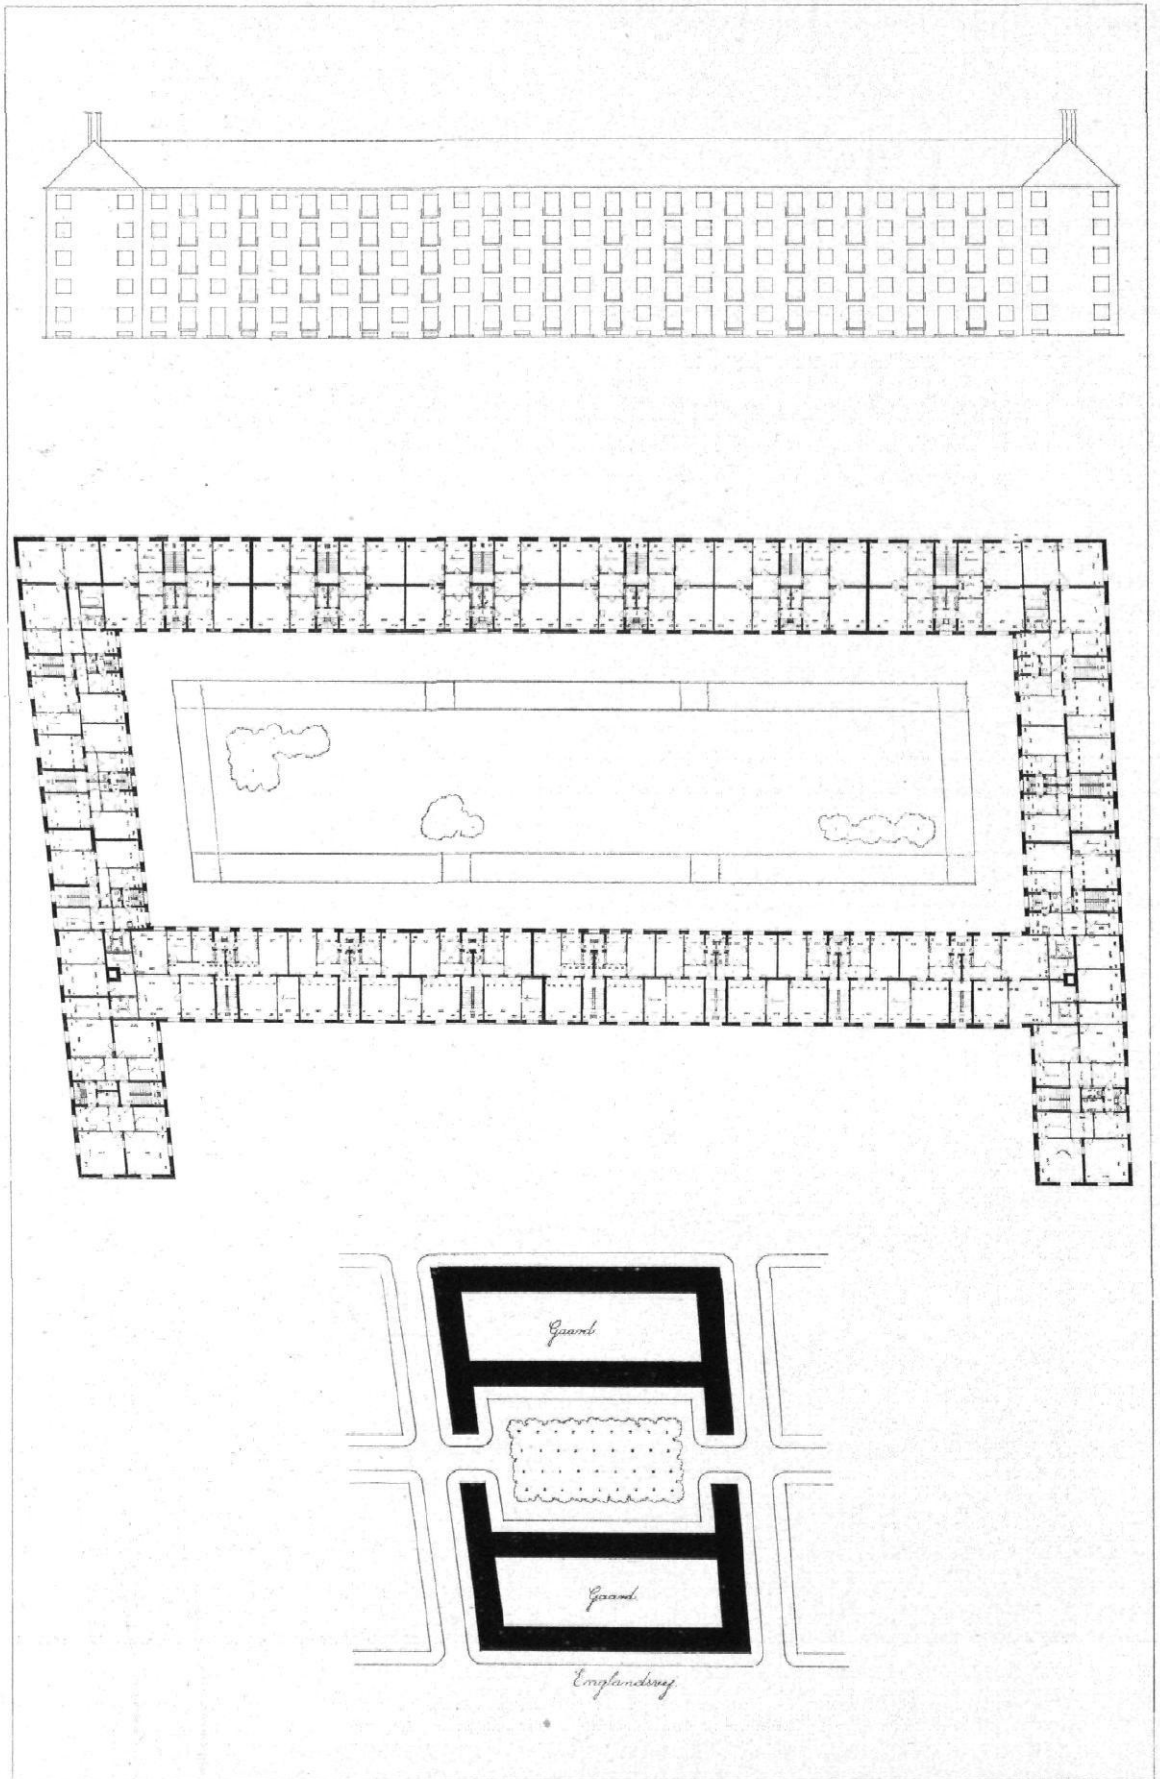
/ Mielsblock in Kopenhagen, Englandsvej | Grundriss und Fassaden 1:800, Übersichtsplan 1:3000
